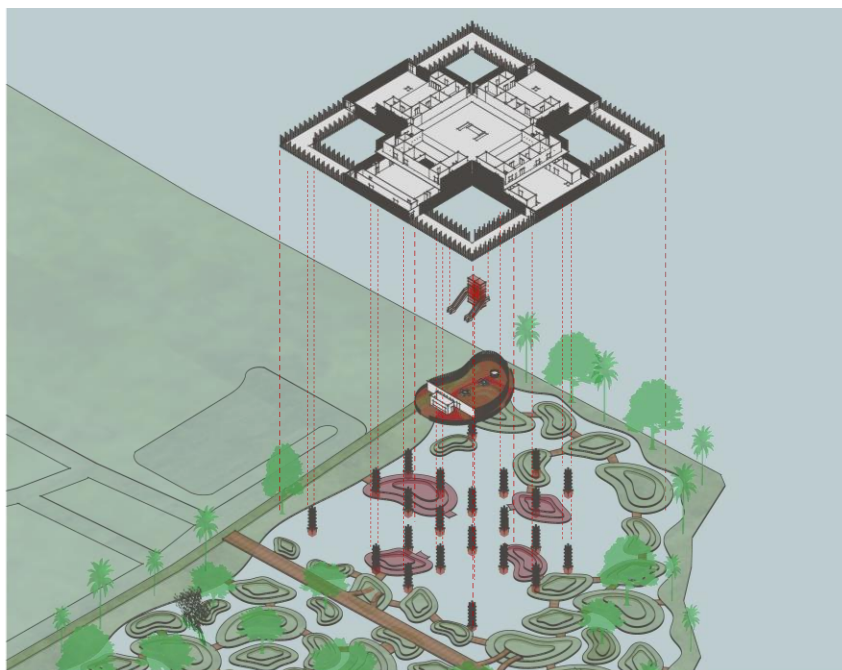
Sistema de acceso: Estructura. Fuente: Elaboración Propia
